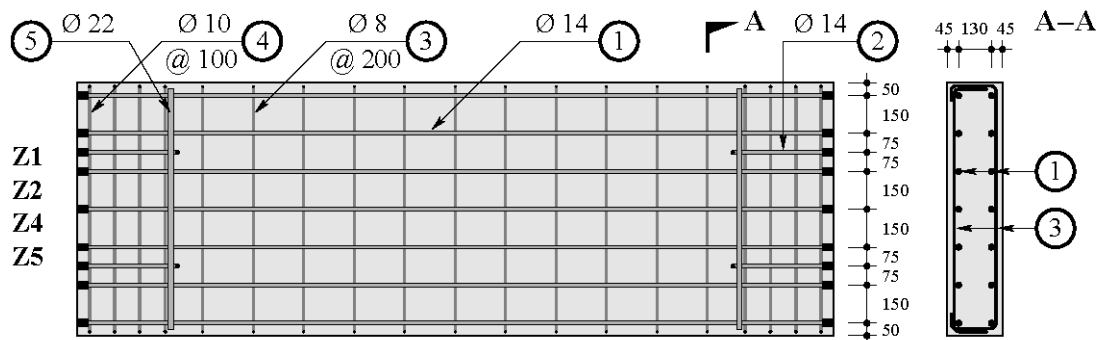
Bewehrungsführung der Versuchskörper Z1, Z2, Z4 und Z5 (aus [2])
